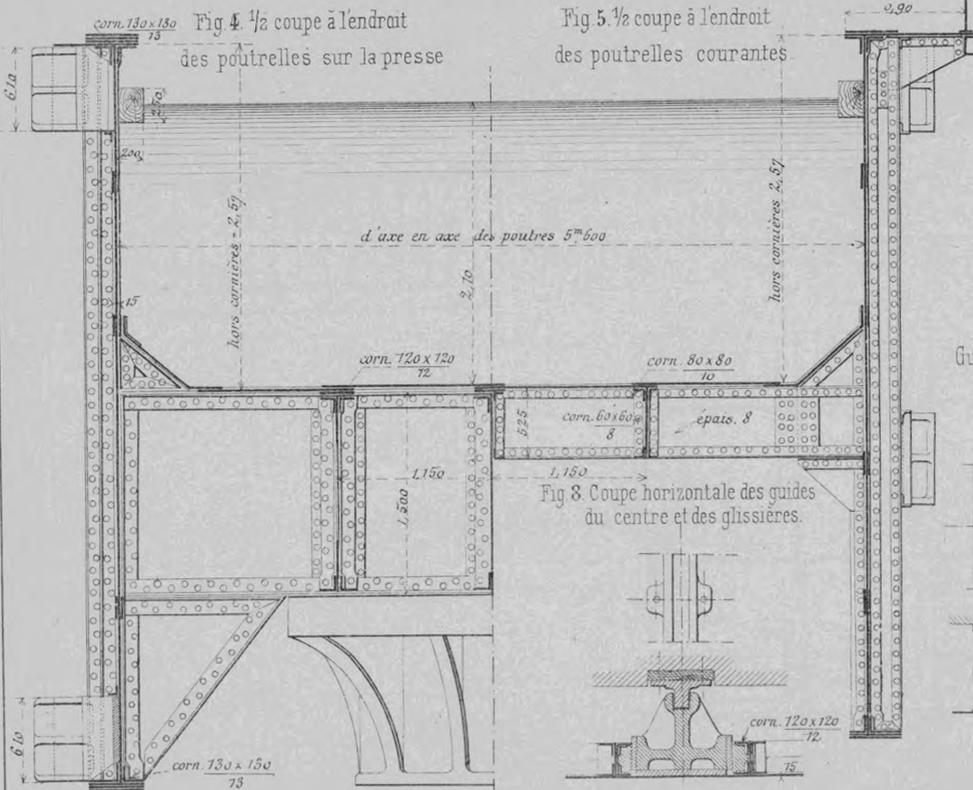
1/2 coupe à l'endroit des poutrelles courantes.
